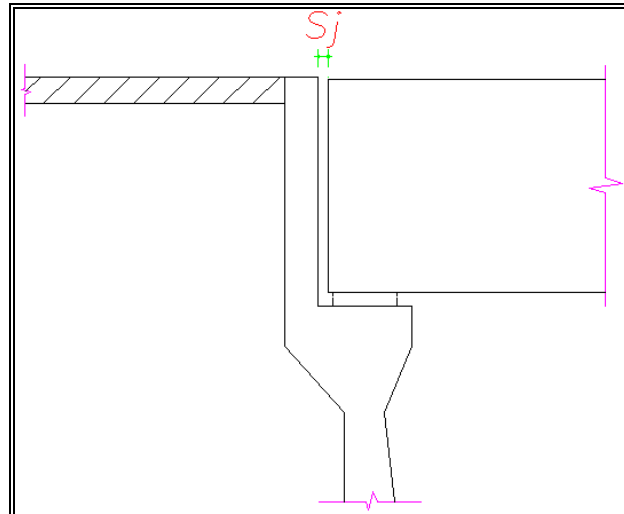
Junta Sísmica entre viga y estribo.
